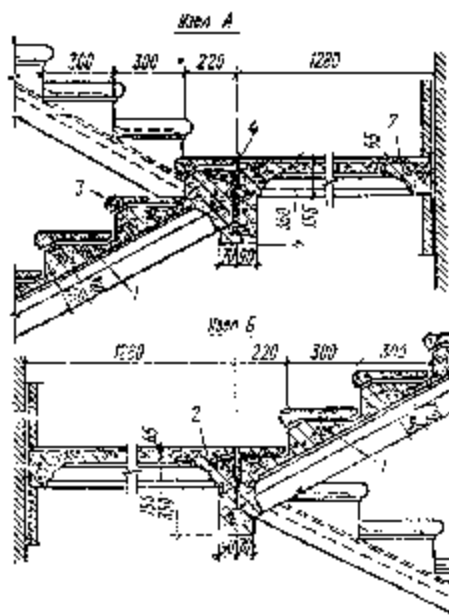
Узлы двухмаршевой лестницы из сборных маршей и площадок с накладными мозаичными проступями: 1 – марш; 2 – плита площадки; 3 – мозаичная ступень; 4 – уголки 150х65х8 мм.
